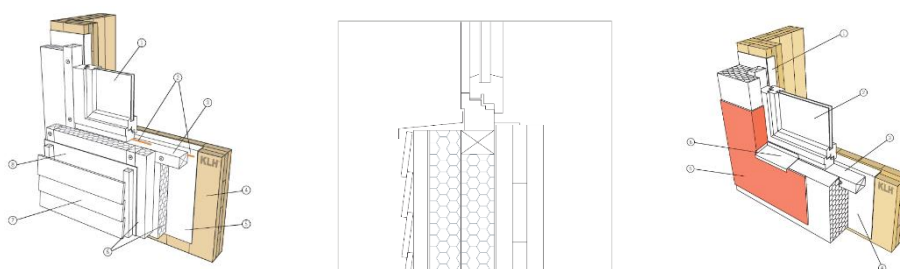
a) Janela e fachada com perfis de madeira e caixa-de-ar; b) Janela e fachada com isolamento e reboco (KLH Massivholz GmbH, 2013b).
